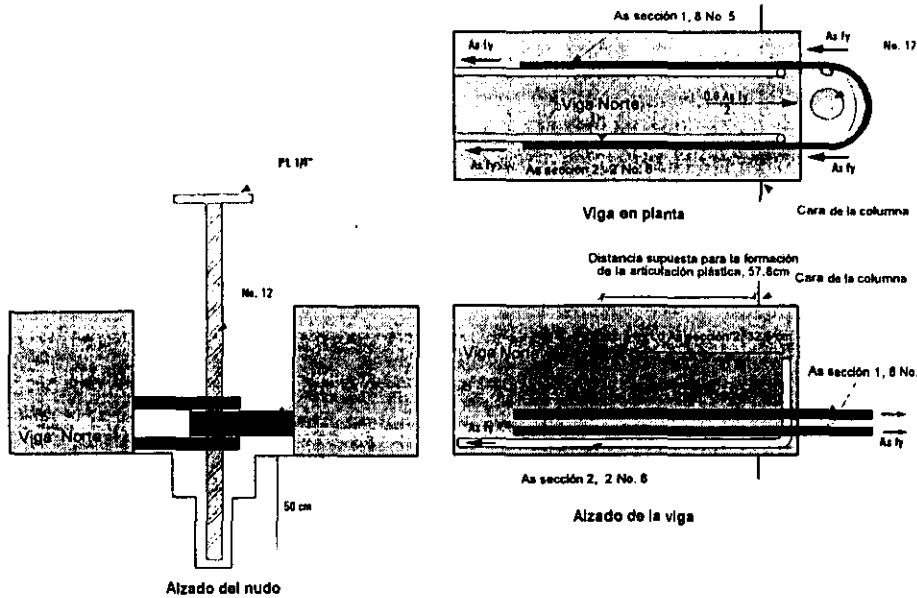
Continuidad del acero de refuerzo positivo de las traves de rigidez
